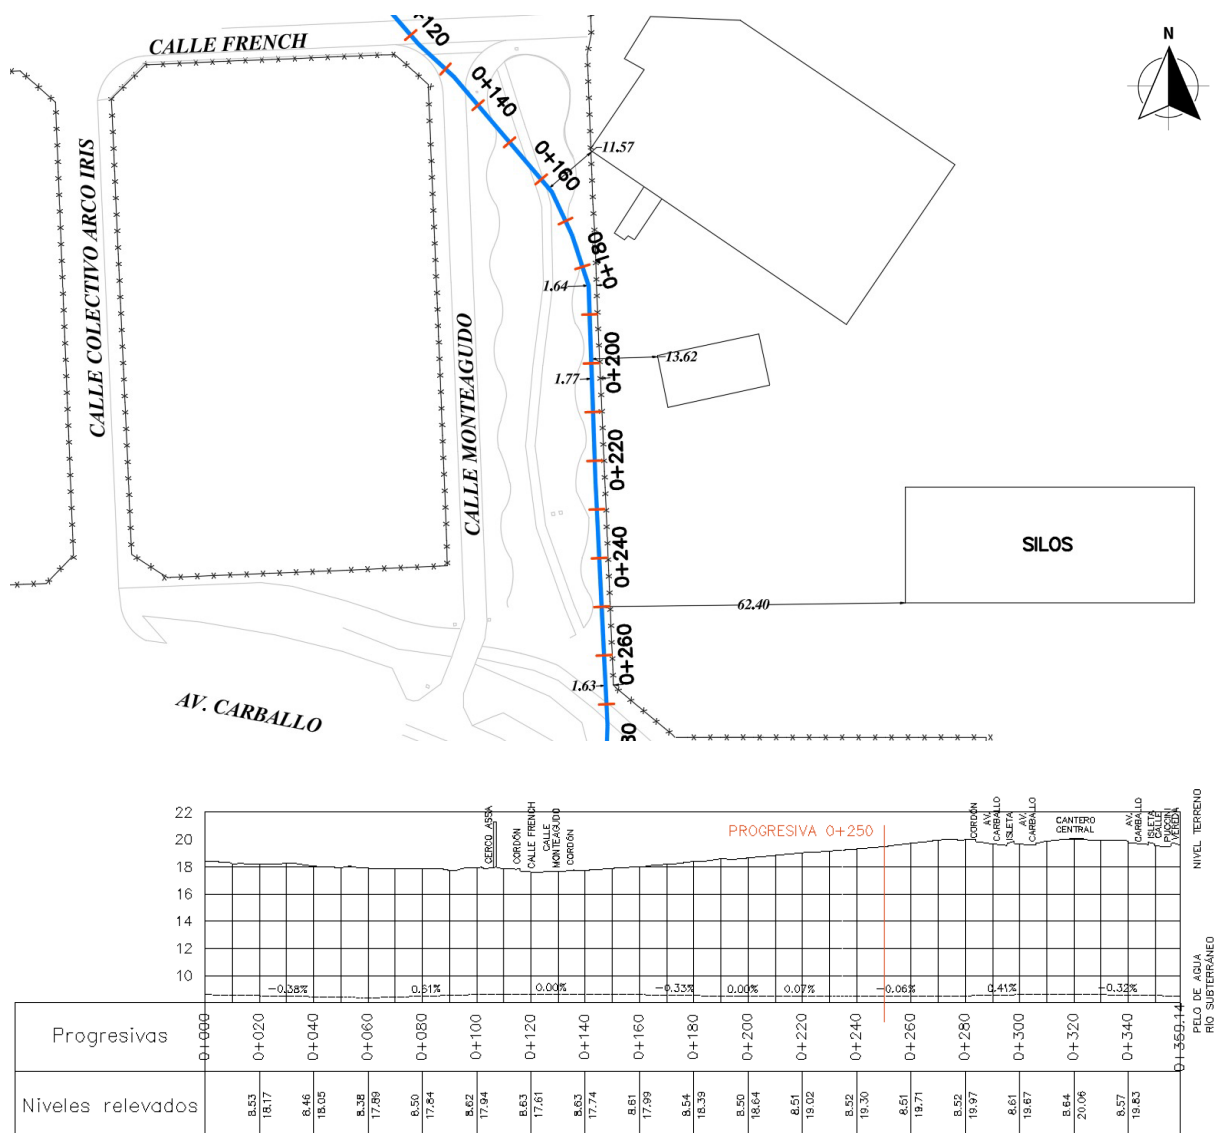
Planimetría y altimetría del conducto y del terreno natural.
